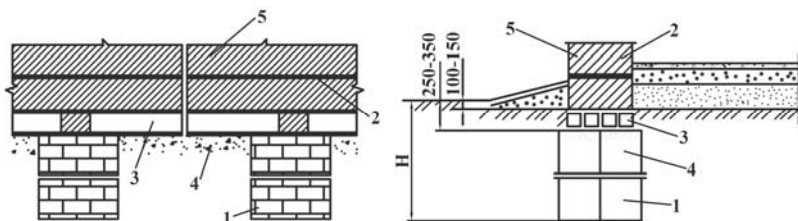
Стовпчасті фундаменти з бутового каменю і перемичкою із збірних залізобетонних брусків:
